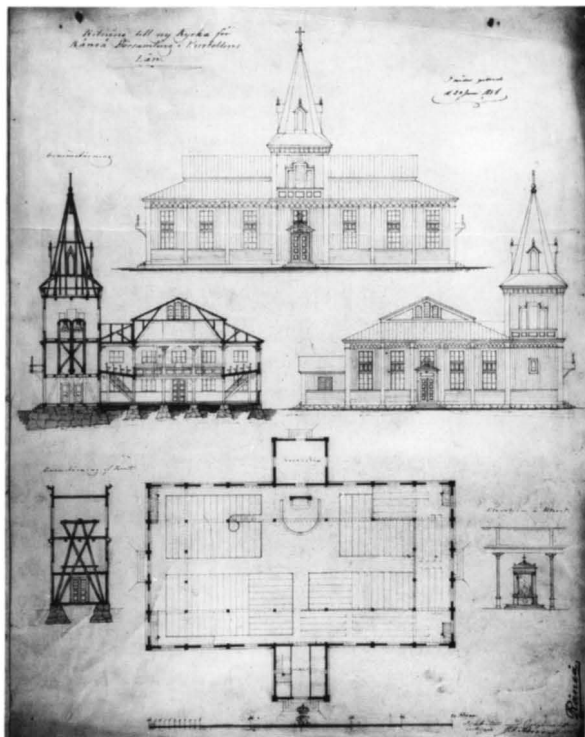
Råneå kyrka. Plan, fasader och sektion, förslag av L Hawerman 1856. RA.
